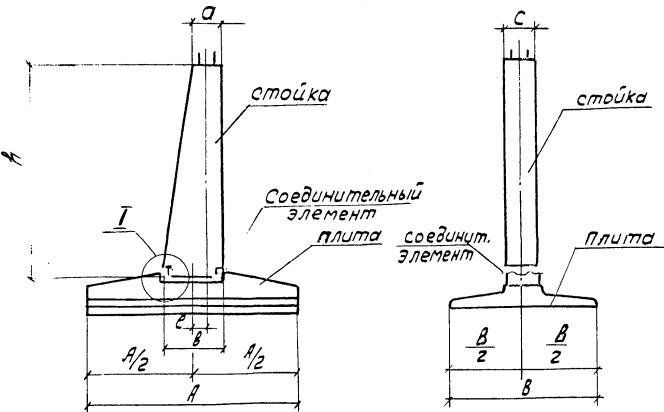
Конструкции железобетонных унифицированных фундаментов.
